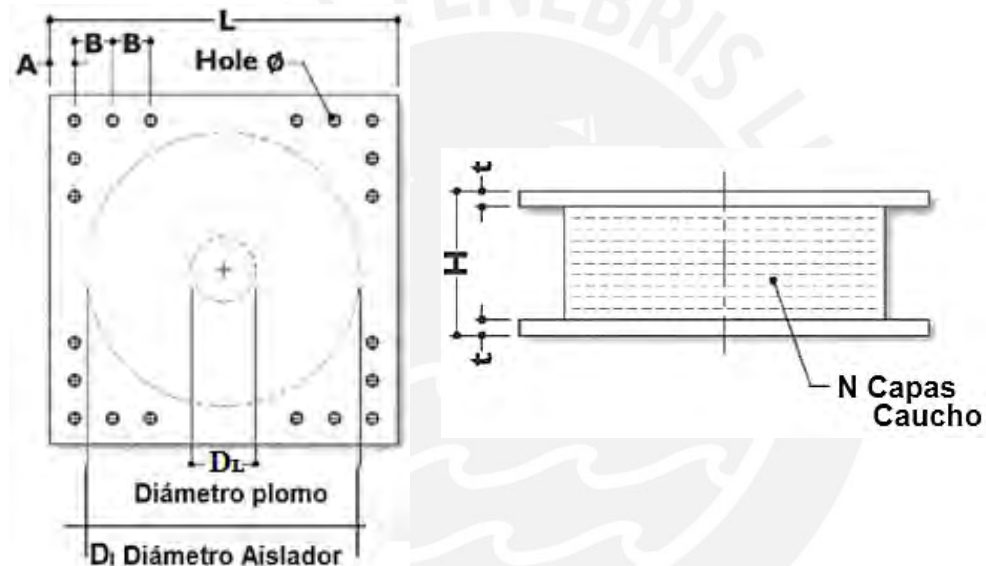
Dimensiones del aislador y de la placa de soporte
